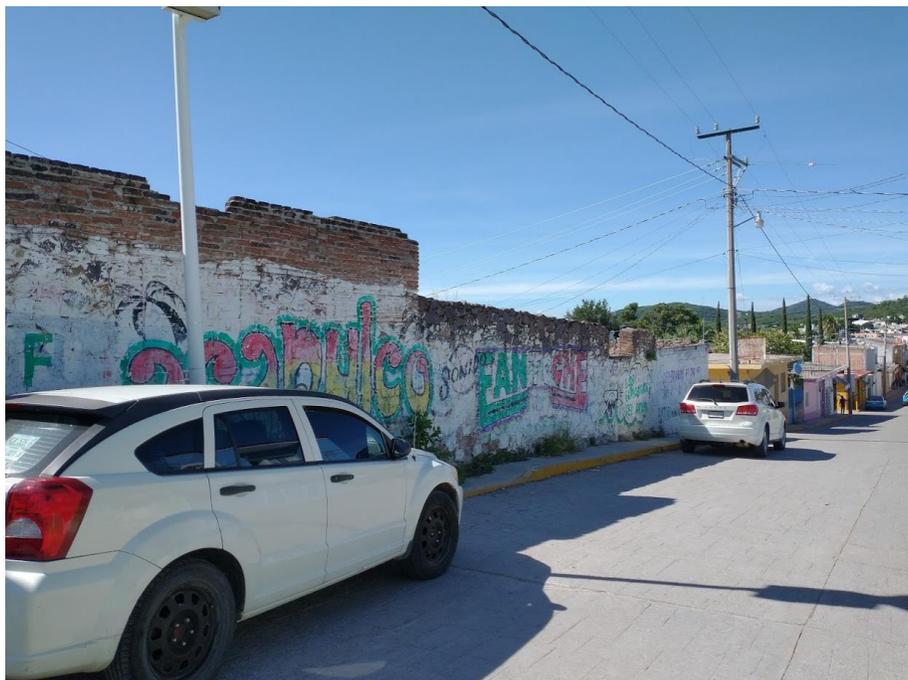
Barda existente en el predio y que será demolida para la construcción.
